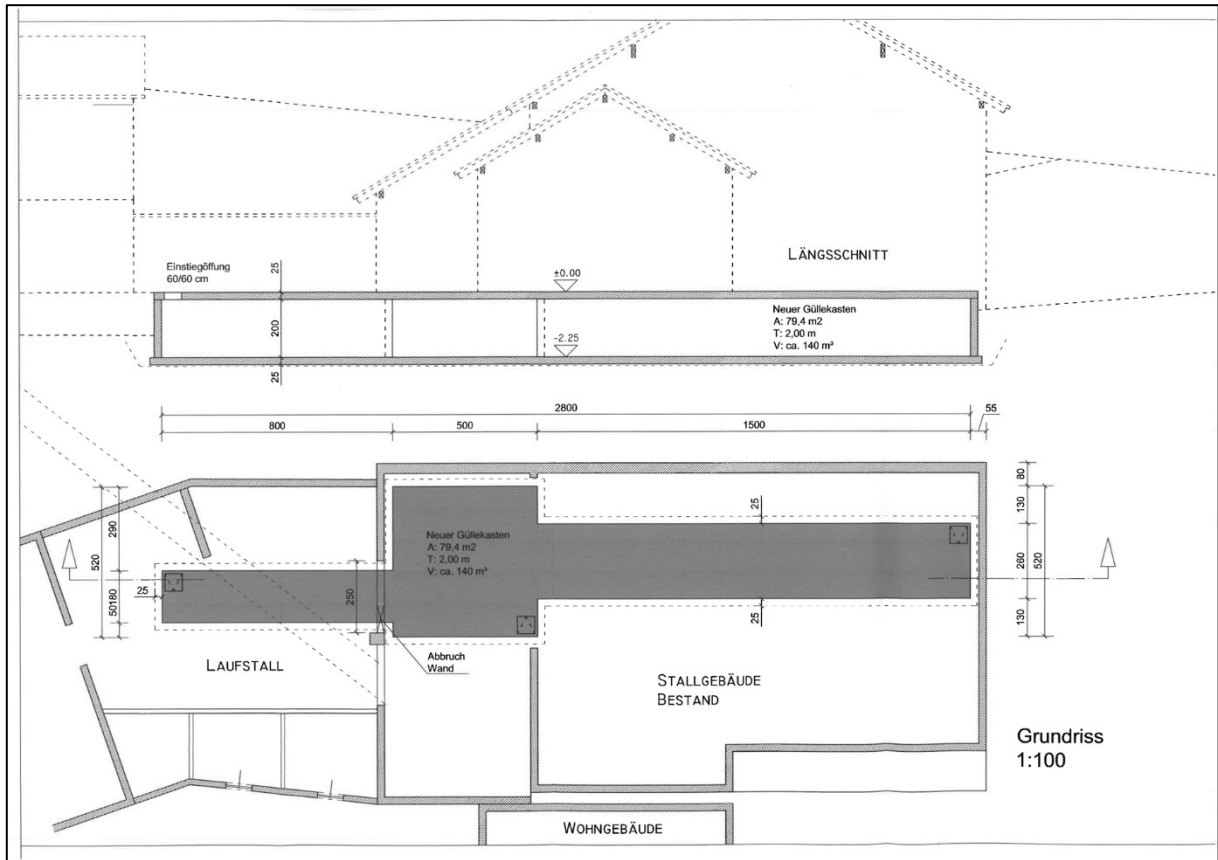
Querschnitt und Grundriss aus dem Einreichplan 2011
